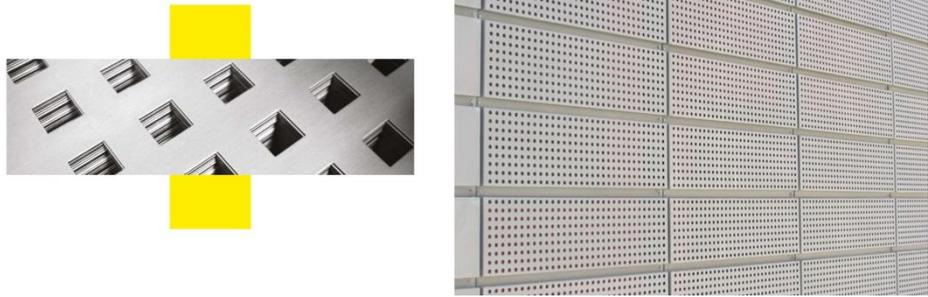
Detalle chapa perforada y aplicación arquitectónica.
